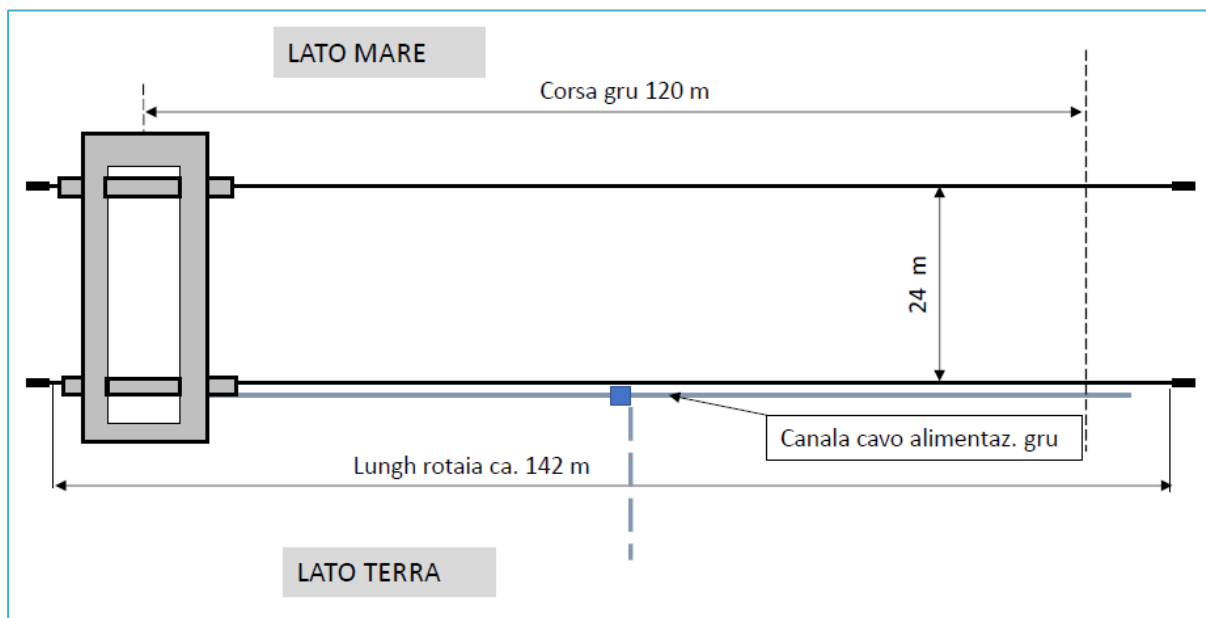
Layout schematico della gru a cavalletto per la movimentazione dei container
